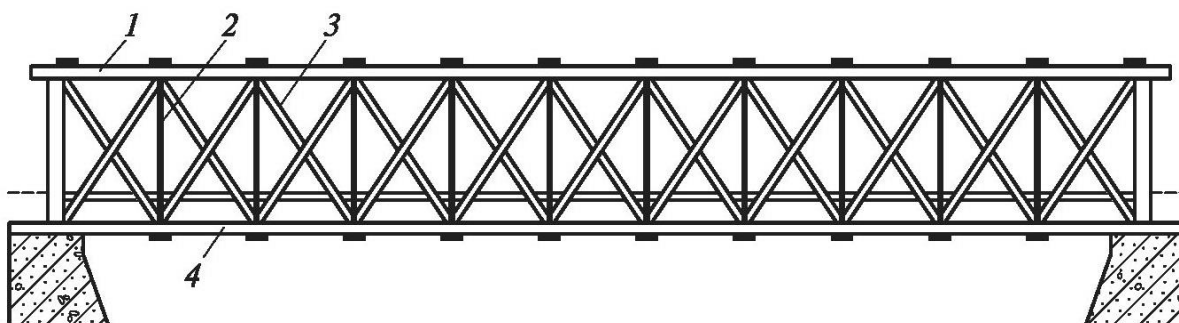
Схема деревянного моста с решетчатыми фермами Гау:
